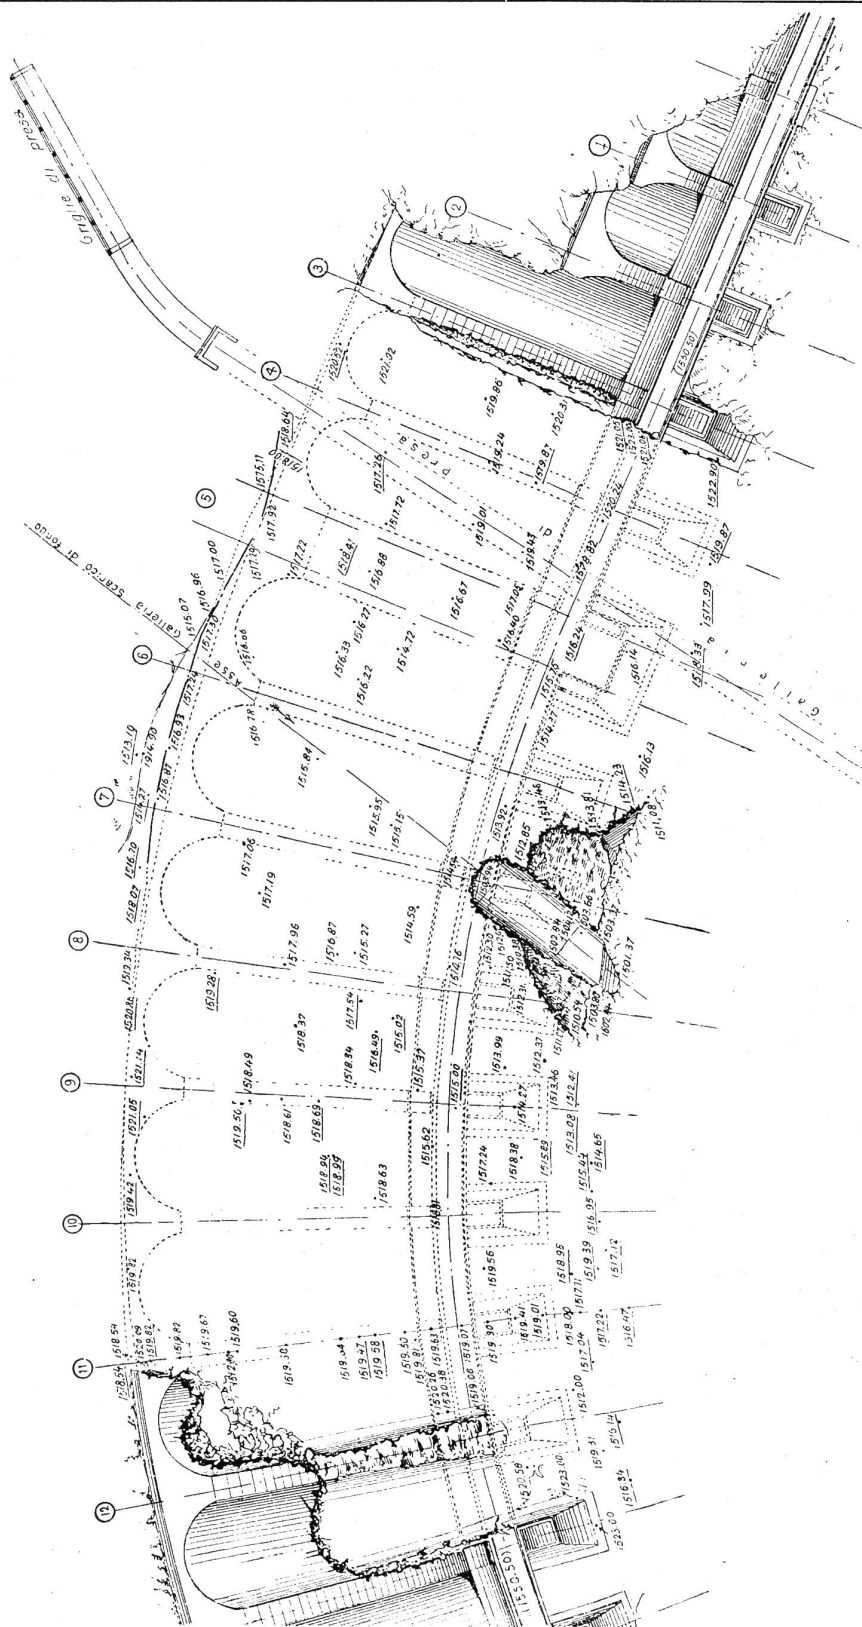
Staumauer vom Val di Gleno. Grundriss der linken Hälfte der Staumauer. Maßstab 1 : 500.
